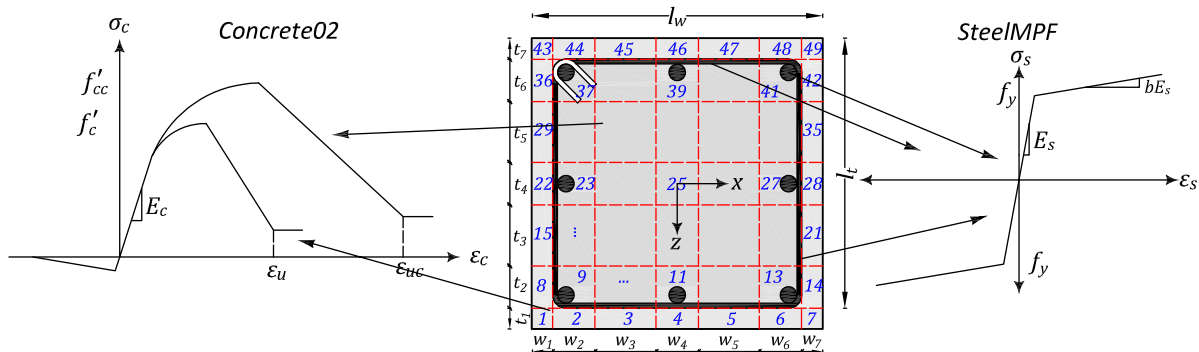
Discretización de la sección transversal del elemento E-SFI-3D mediante prismas de hormigón armado.
